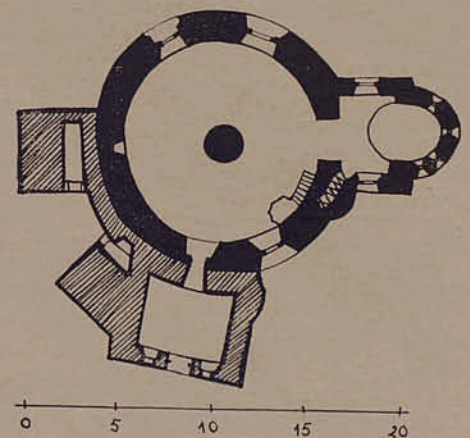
Planta baja de la iglesia de San Olao de Ols
